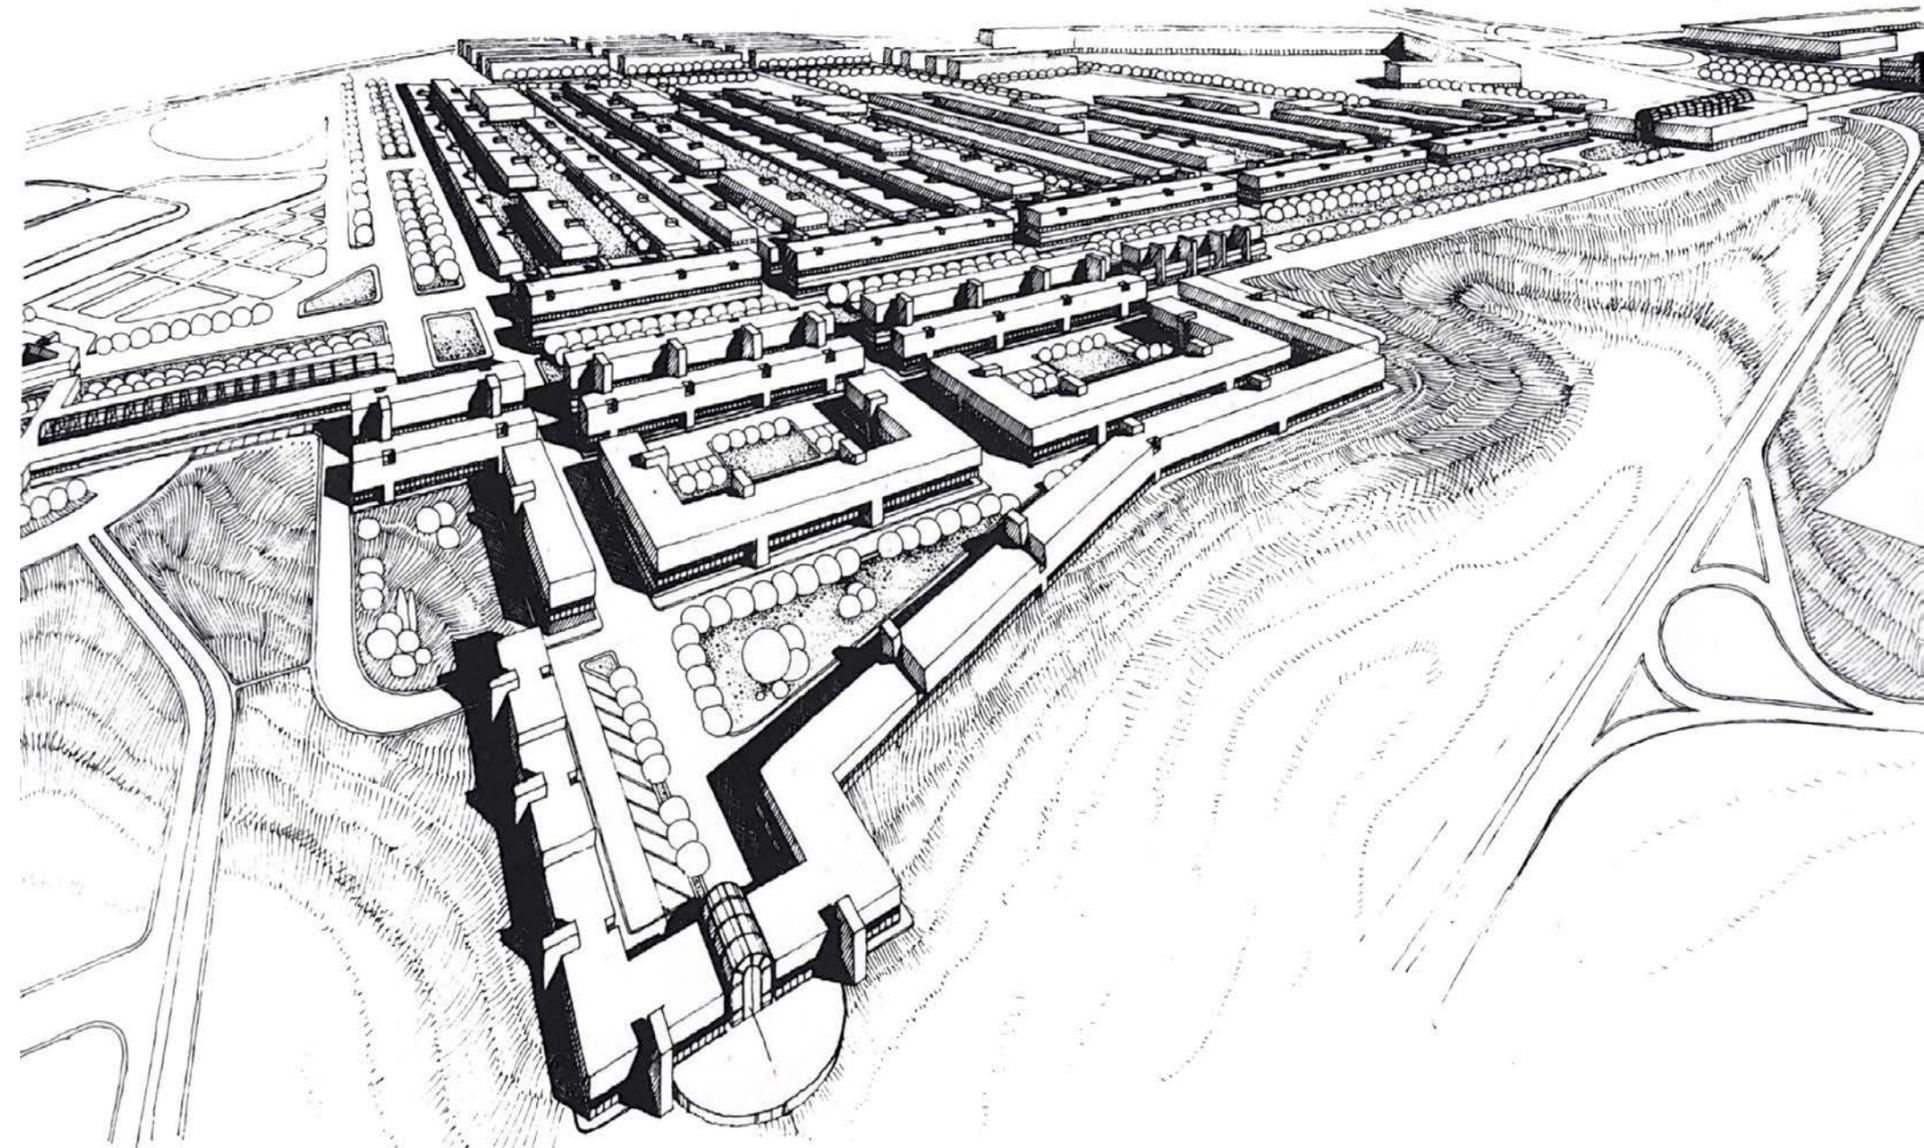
Prospettiva di progetto del Piano di Zona di Casal Monastero
